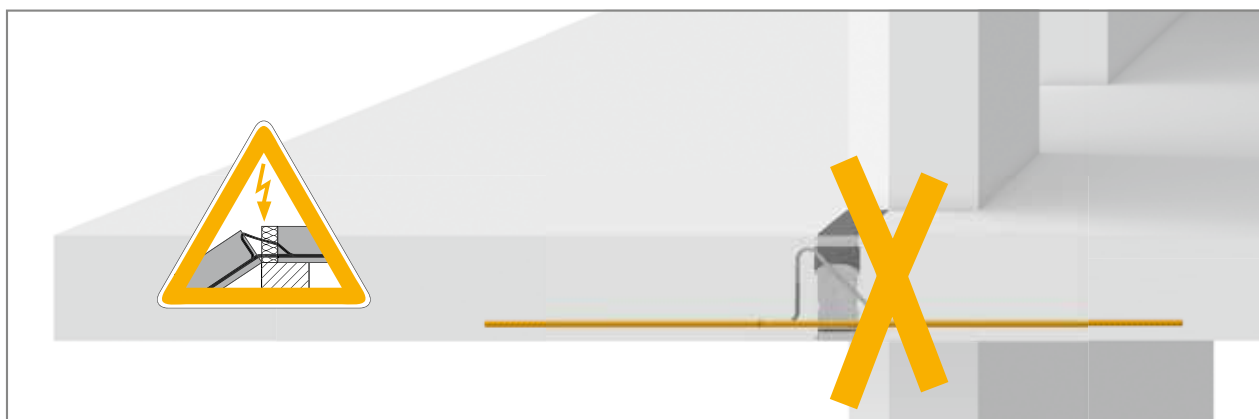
Schöck Isokorb® T tipo KL e la posa sbagliata: barra tesa sul lato inferiore
